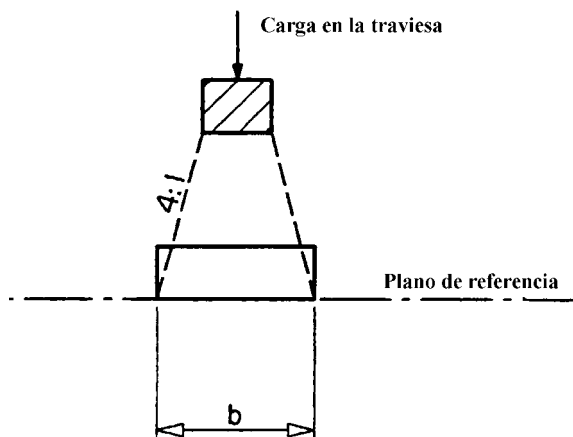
Distribución longitudinal de la carga a través de las traviesas y el balasto
